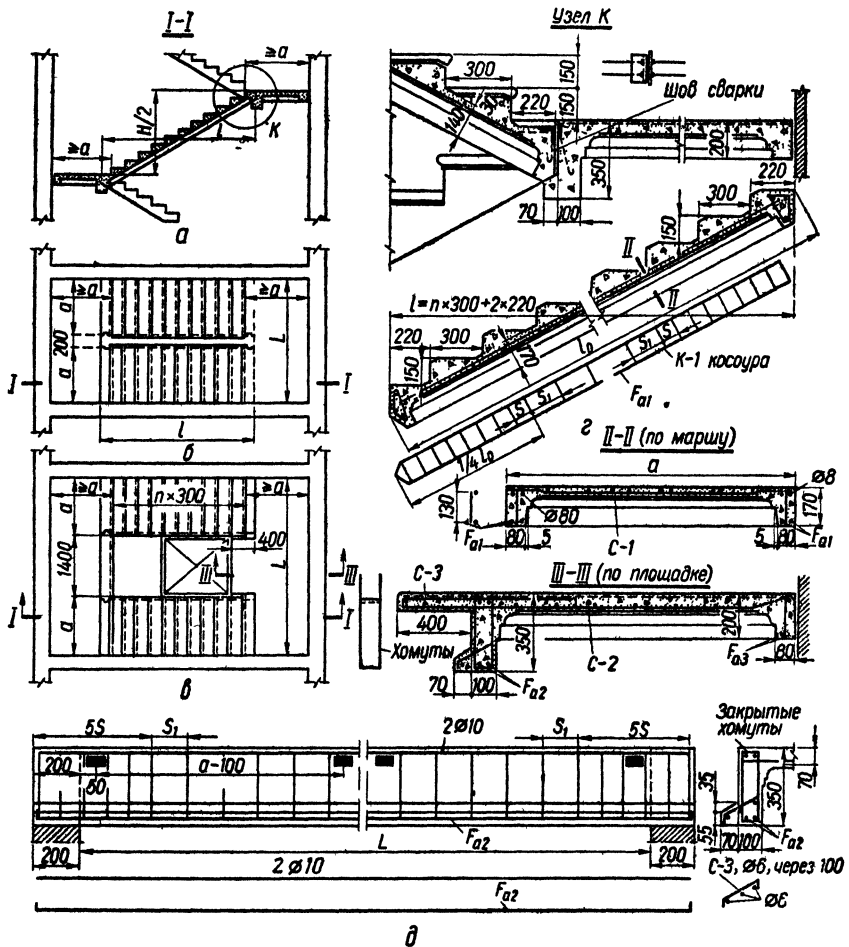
Детали сборной железобетонной двухмаршевой лестницы
